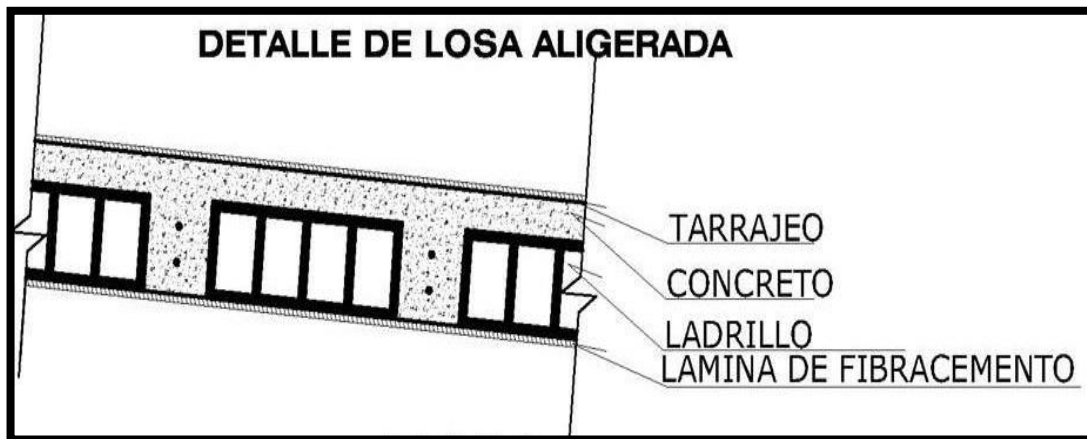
Detalle del aislamiento de cubiertas inclinadas en aulas académicas.
